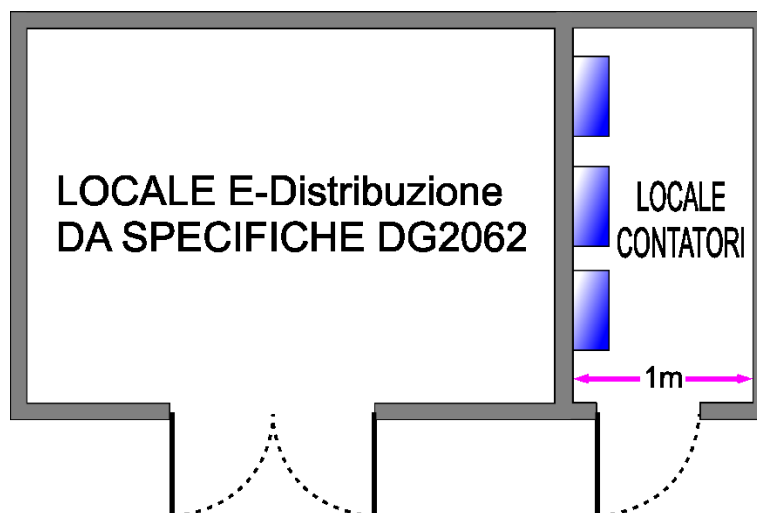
Layout indicativo cabina E-Distribuzione minibox con aggiunta locale a protezione contatori.
